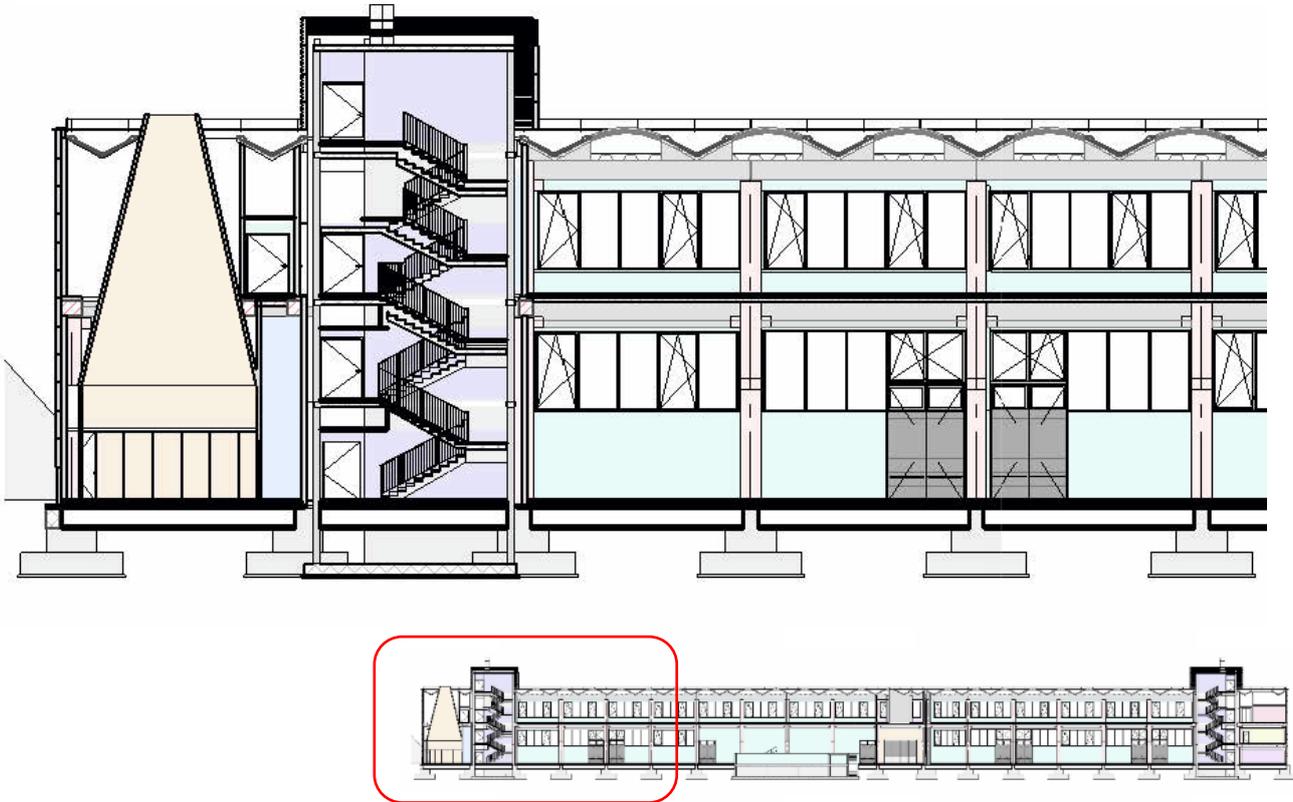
Sezione longitudinale con dettaglio dei plinti di fondazione
